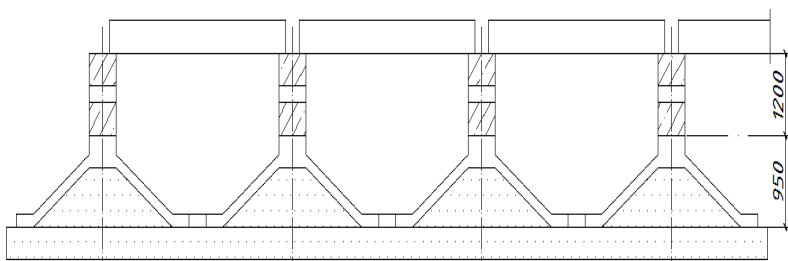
Многоволновые фундаменты-оболочки жилых домов – сборные фундаменты – складки на вечномёрзлых грунтах
